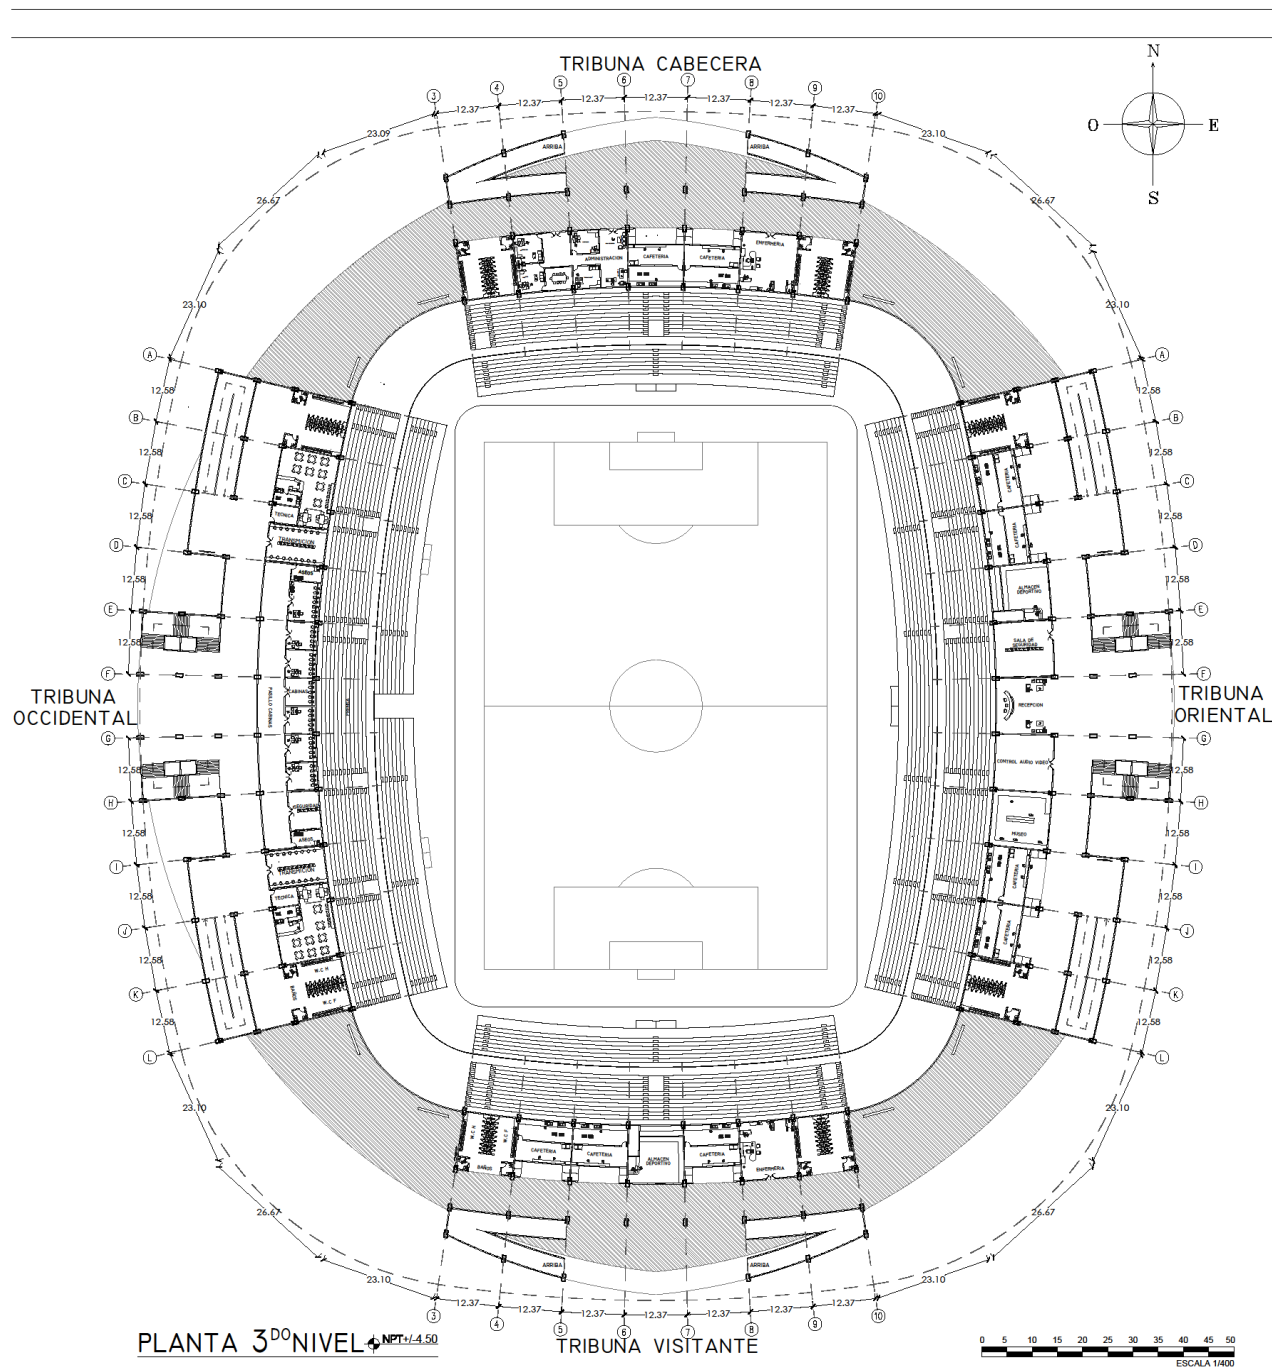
Planta 3 / Fuente Elaboración Propia
